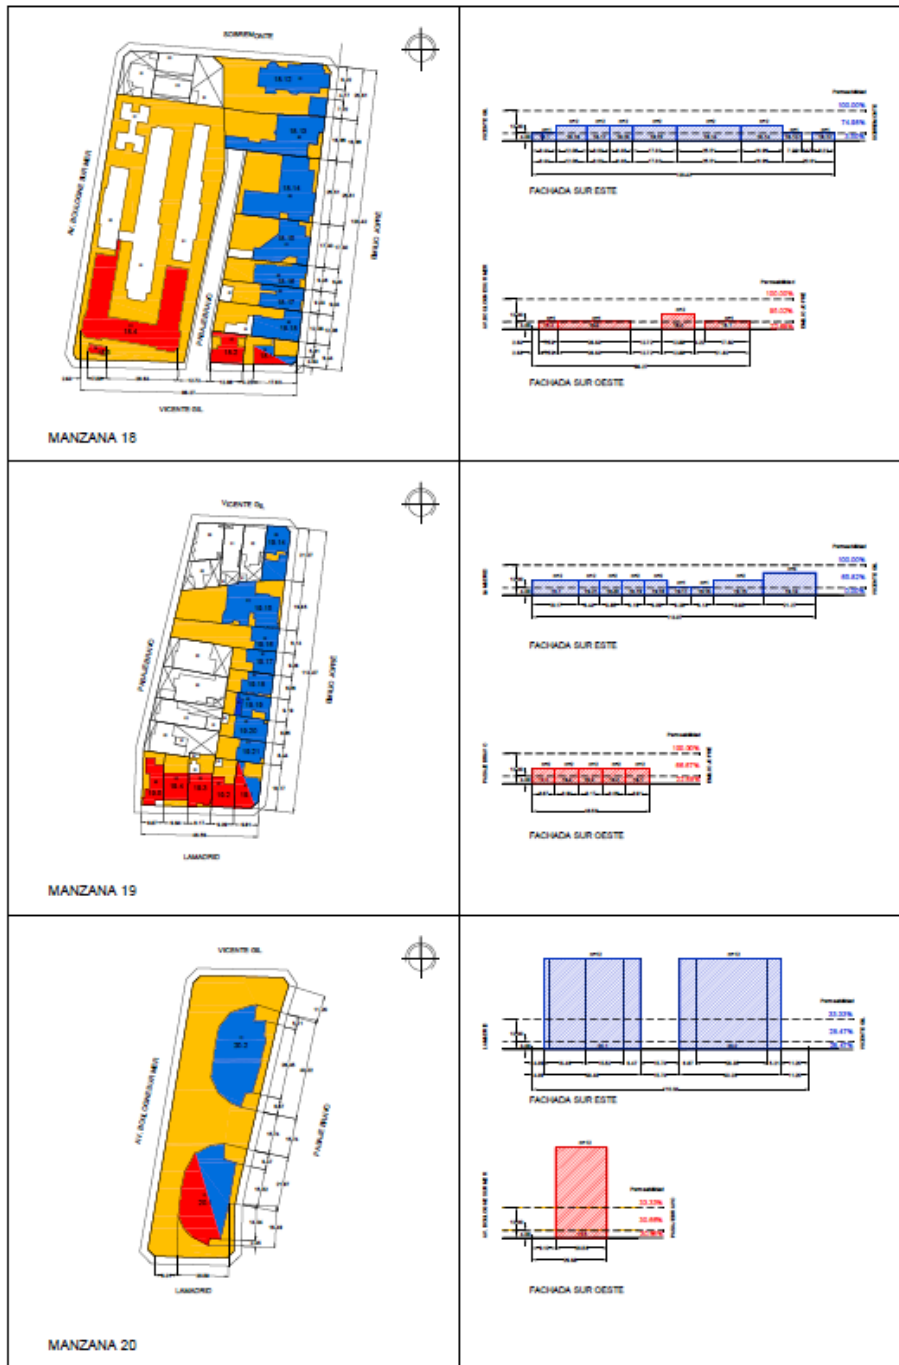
Plano de permeabilidad de fachadas – Manzanas 18 a 20 – Zona Torres B. Sur Mer
